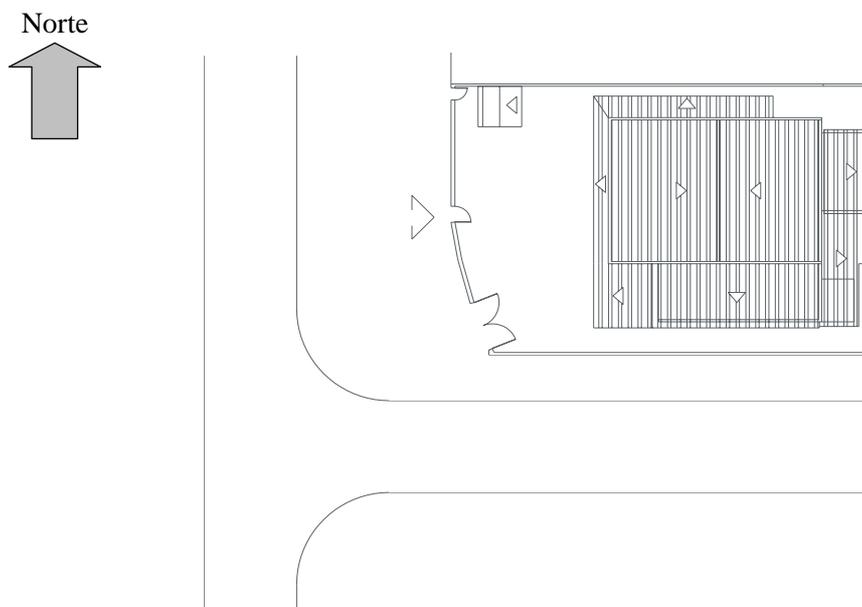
Ilustração mostrando a Planta de Cobertura e a de Situação (Fonte: CIESZO).
